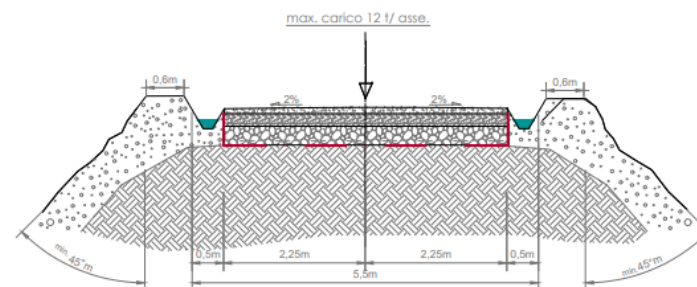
Sezione stradale tipo con scarpata (mezza costa)
